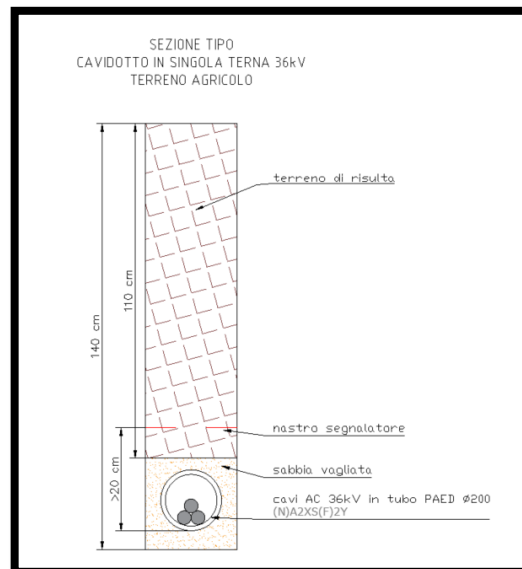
Sezione tipo cavi a 36 kV su terreno
